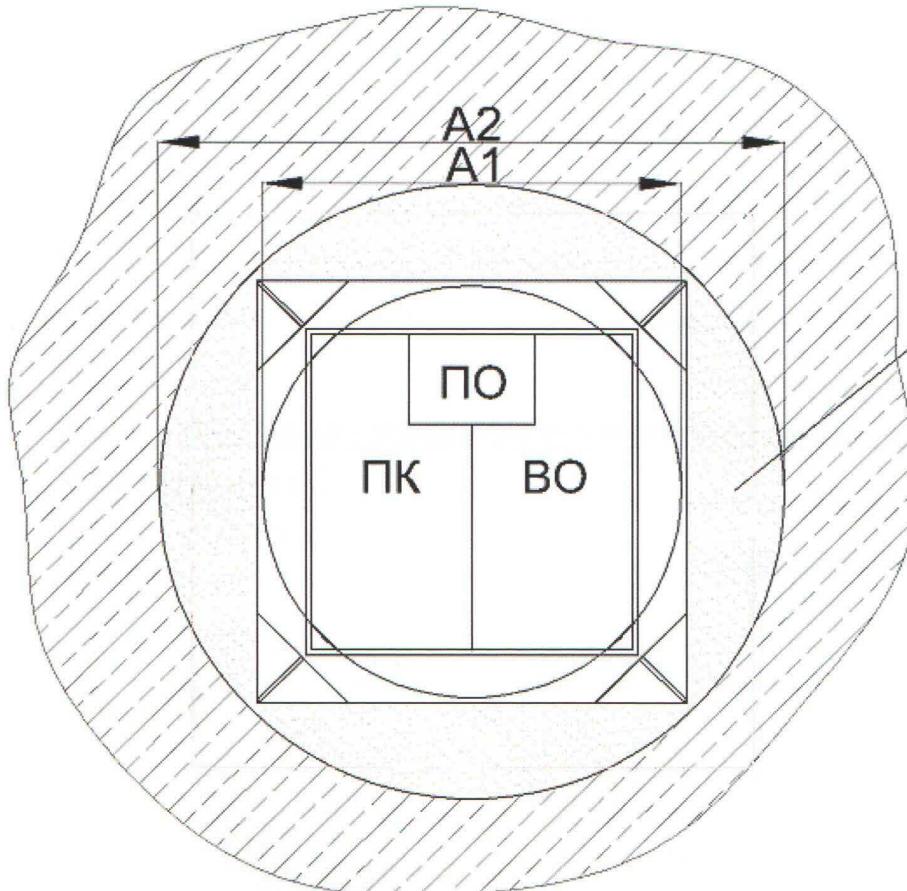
Обозначение габаритных размеров станции «ЕВРОБИОН - КЛАССИК»
